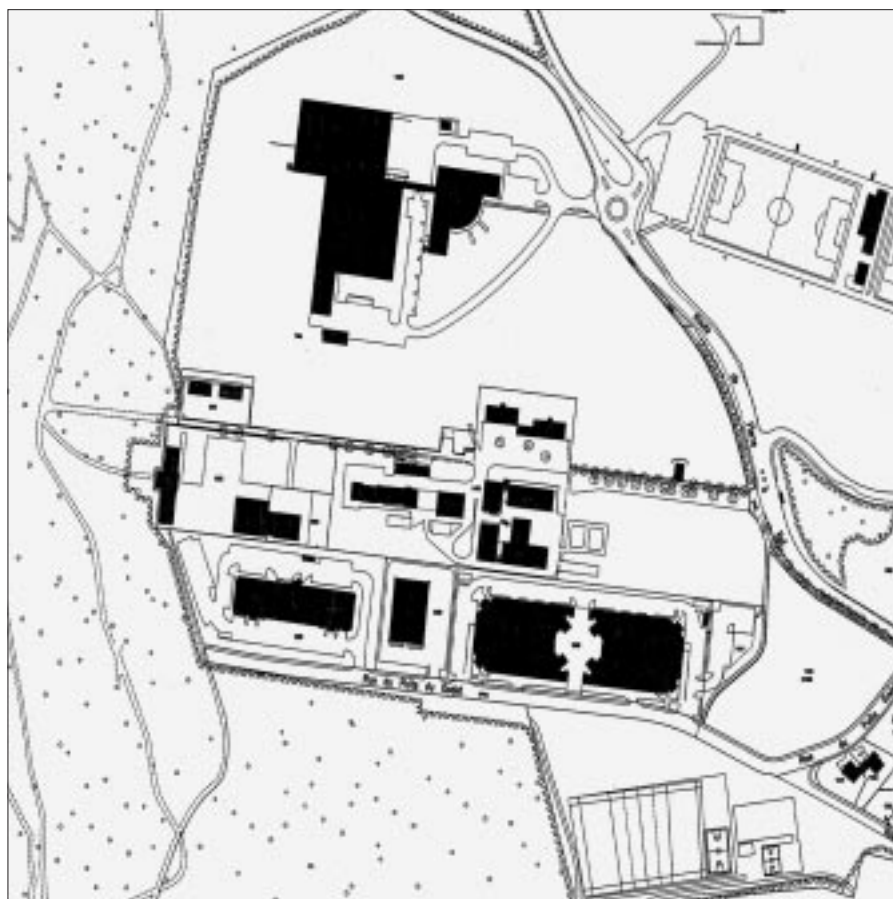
Plan de situation. En haut à gauche, l'usine construite actuellement.
